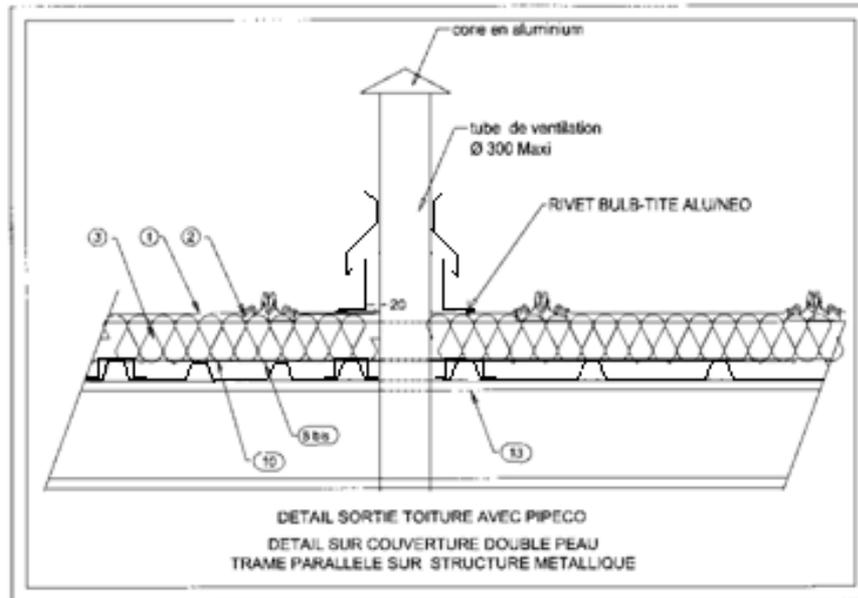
Raccord sur conduit en pénétration (épaisseur 1 mm) – pente  $\geq 5\%$
